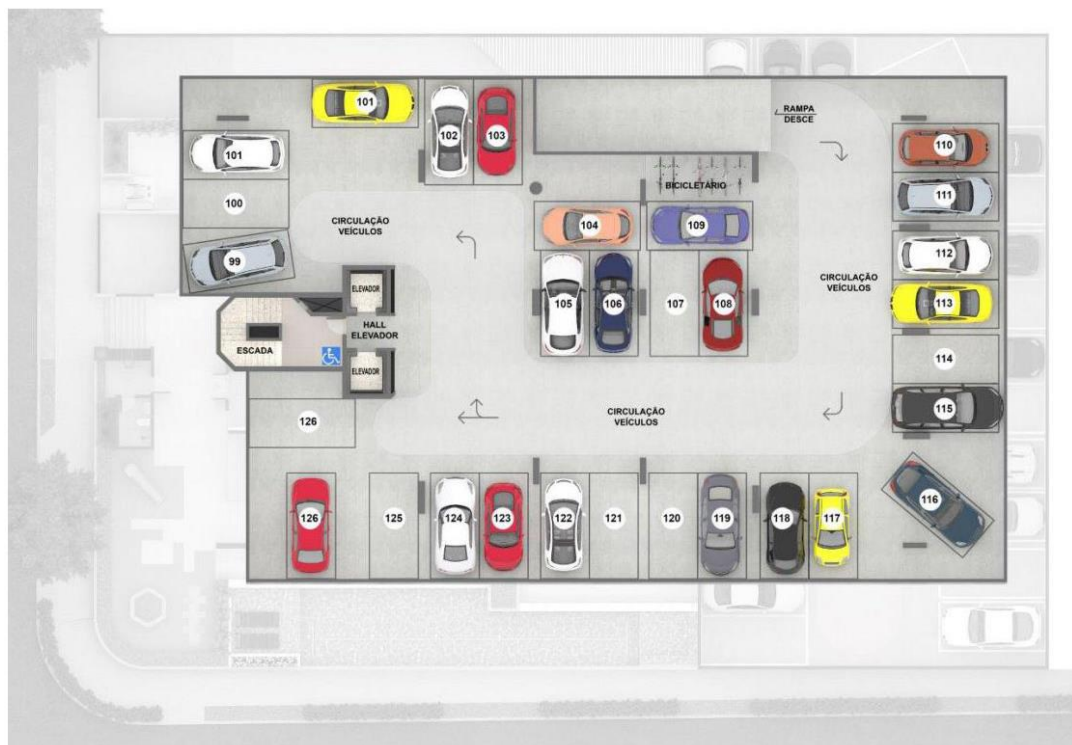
Vista superior do pavimento garagem 02 (imagem ilustrativa)
